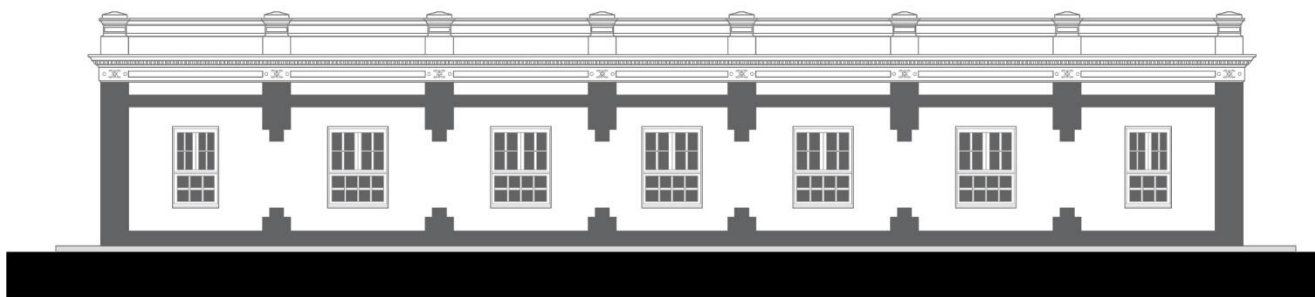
Fachada sul. Neste desenho foram utilizados para toda a fachada os modelos de janelas tipo guilhotina, provavelmente o sistema original.
